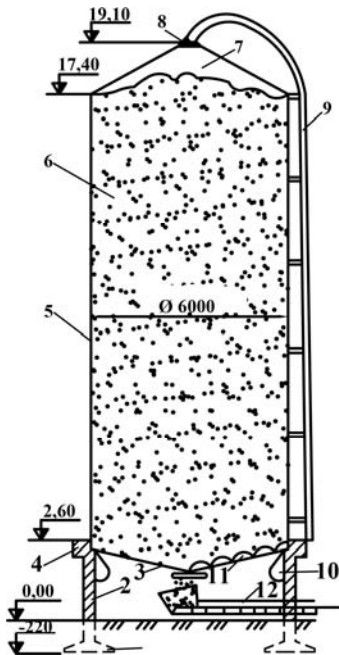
Металева герметична башта для сінажу з нижнім розвантаженням:
